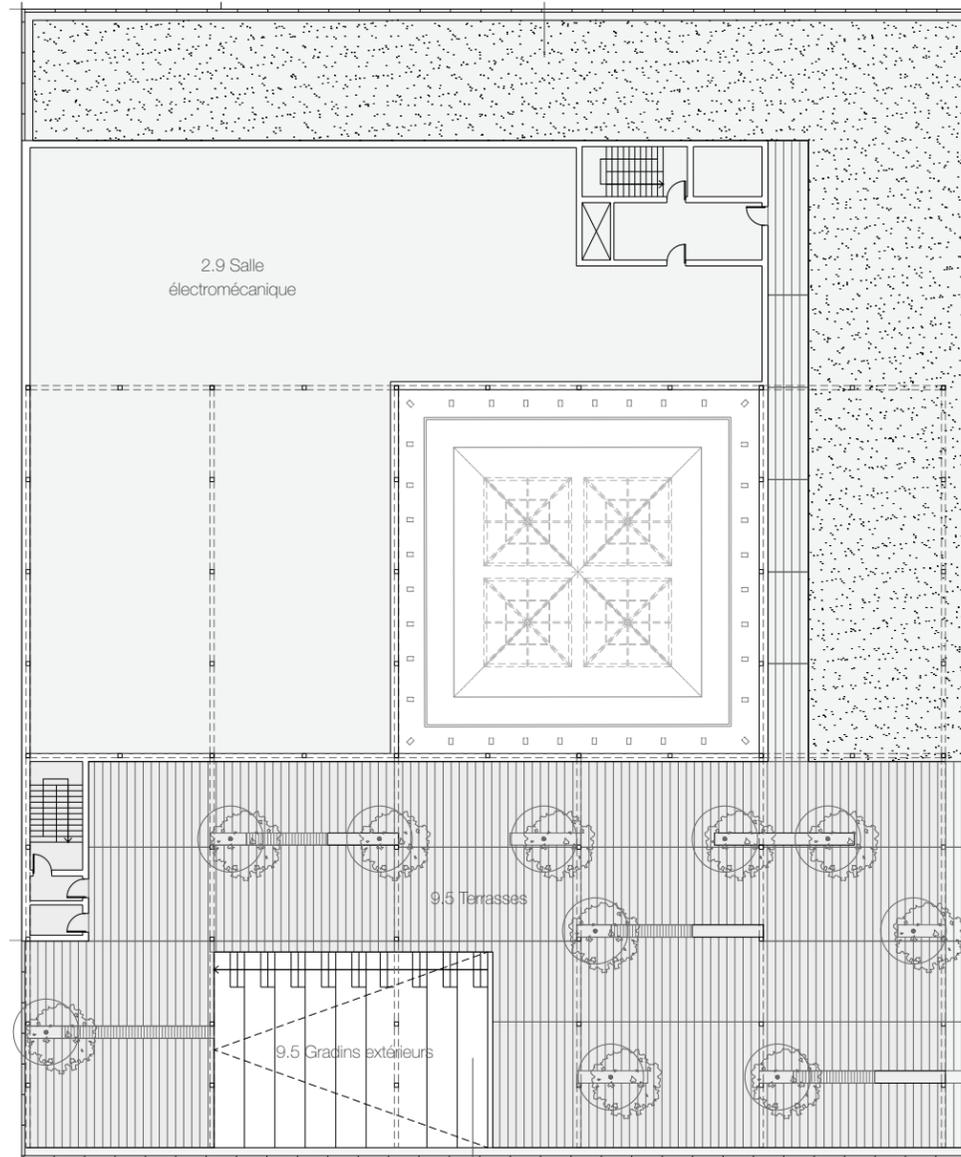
Plan de la toiture de la nouvelle BGR - Crédit : Saucier + Perrotte / GLCRM
